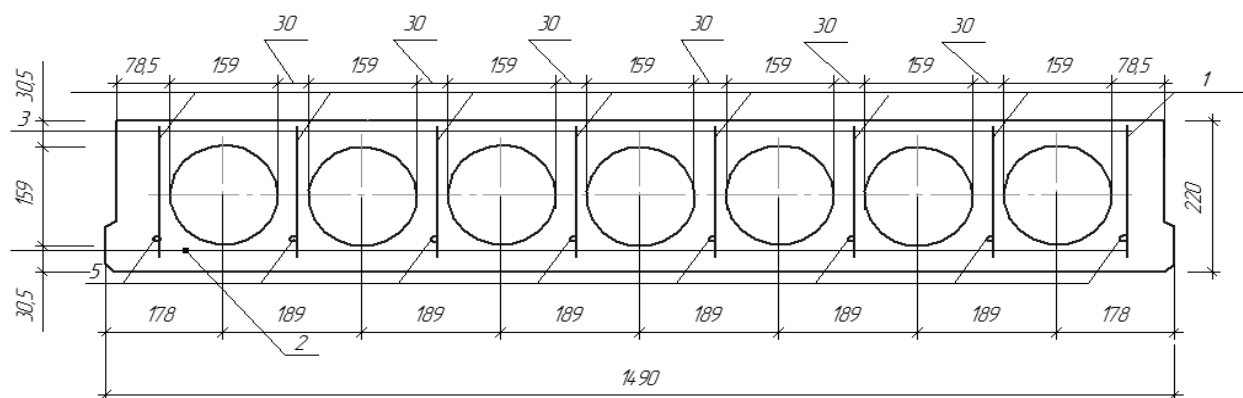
Поперечний переріз багатопустотної плити перекриття
